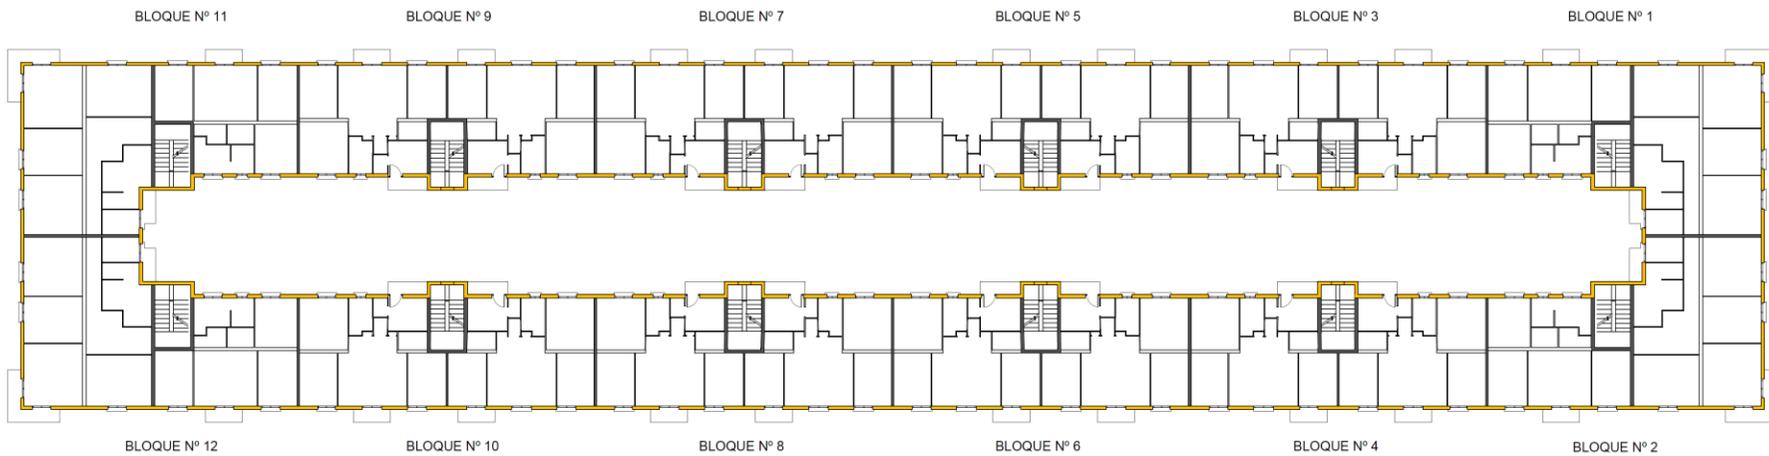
Sección en el bloque de edificios por la planta 2, amarillo la fachada y en negro la partición vivienda-vivienda.
